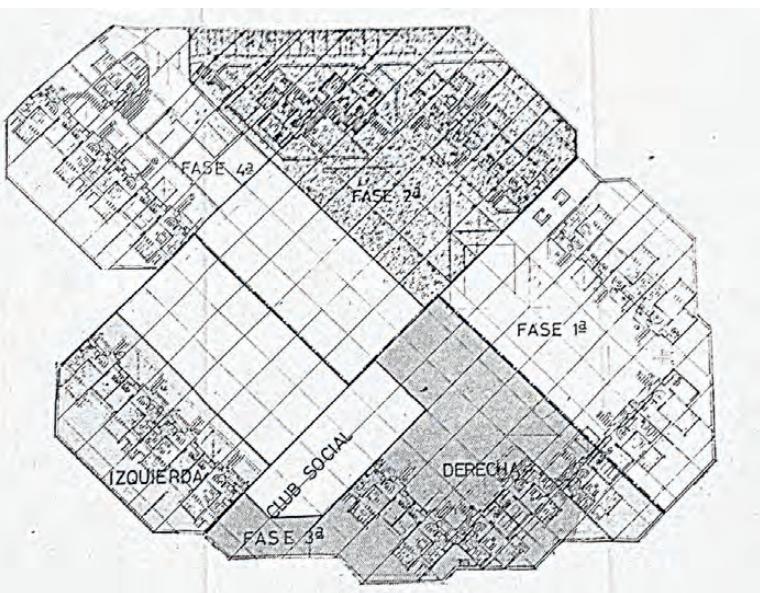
Plano trama y fases del proyecto Espai Vert (2016) / Figure 4. Layout Plan and Project Phases of Espai Vert (2016).
